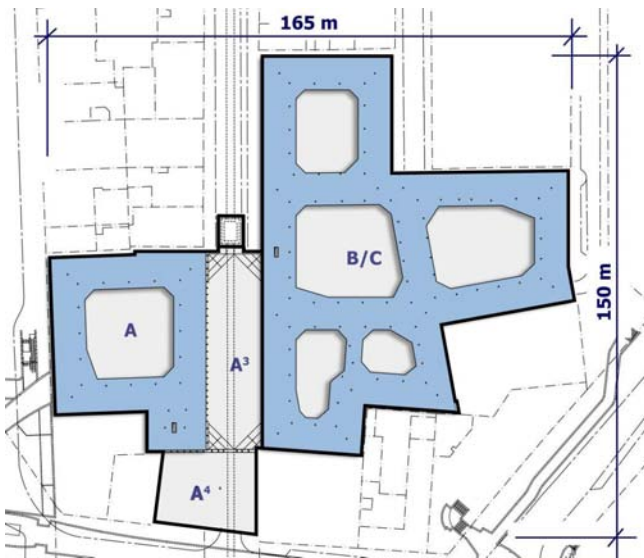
Grundriss Aussteifungslagen 2 bis 6
